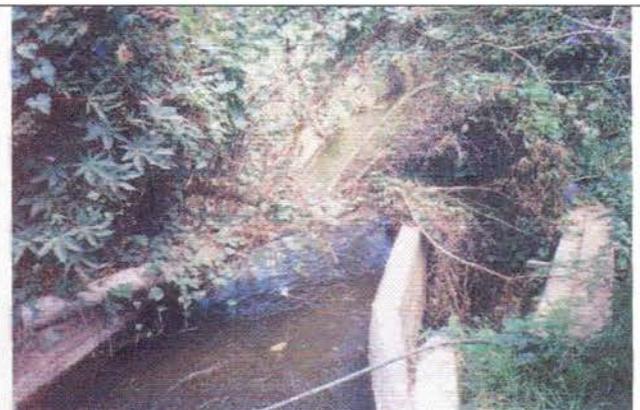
Canoa. Estructura de hormigón en paso del canal sobre quebrada Chinchorro.
